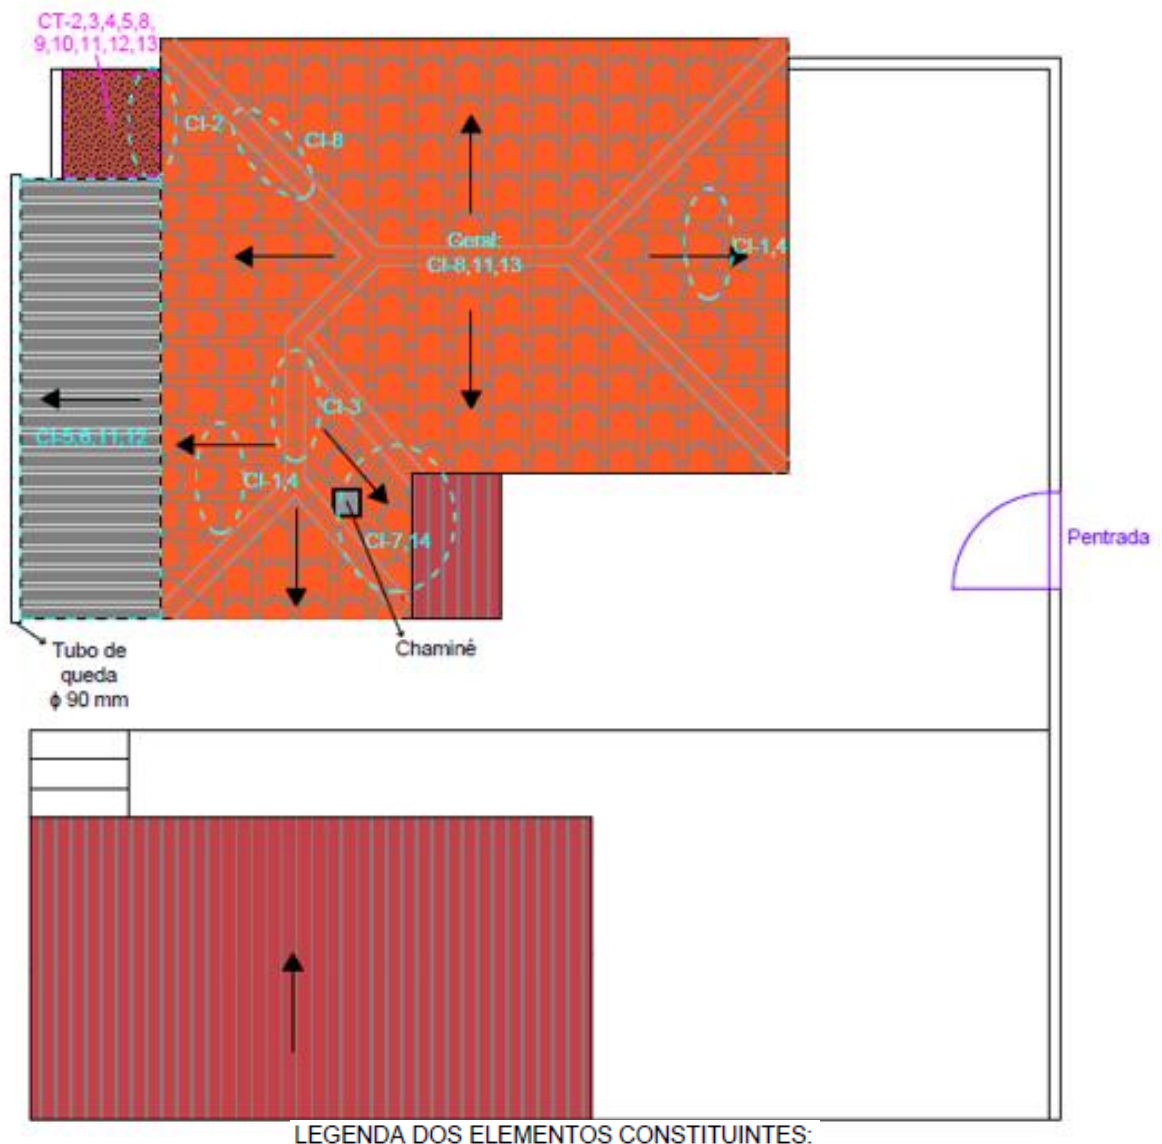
Mapeamento dos danos (planta geral da habitação)
